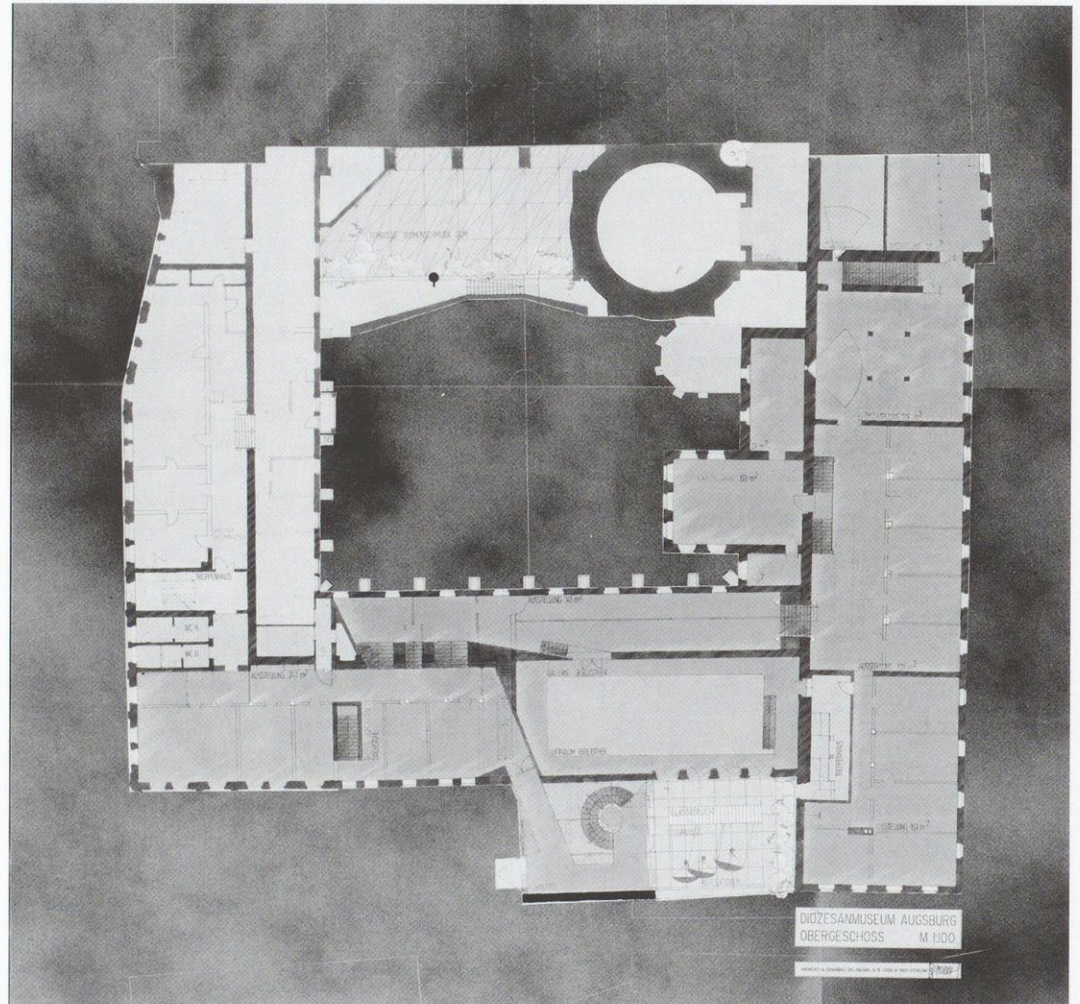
Grundriß 1. Obergeschoß, Vorentwurf 1989
